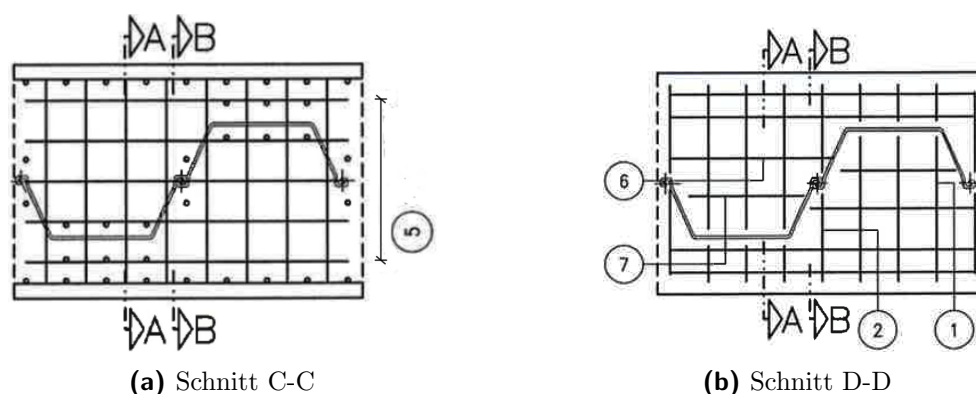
Bewehrungsanordnung für Vertikal- und Horizontallasten [6]
